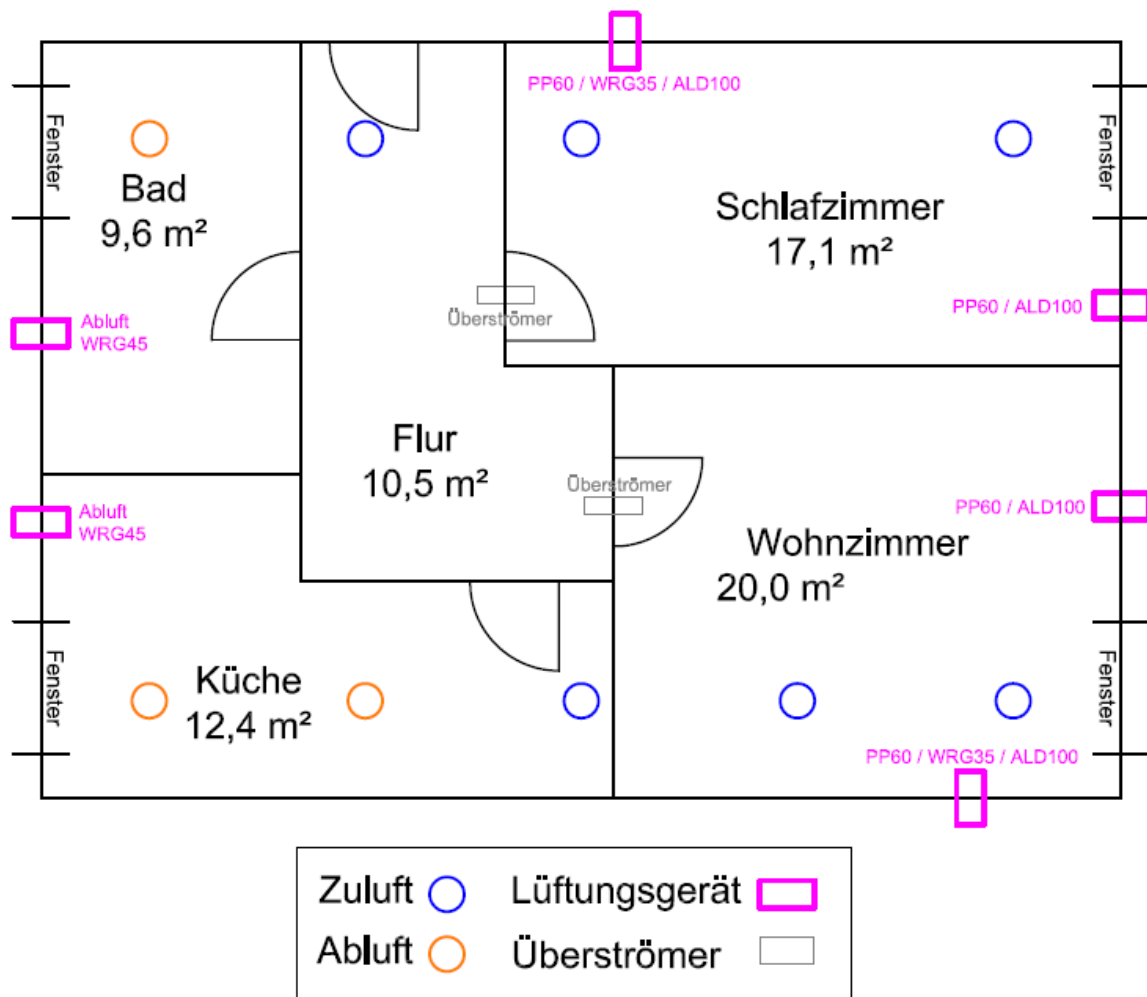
Grundrissplan der Forschungswohnung inkl. Positionen der Lüftungsgeräte
